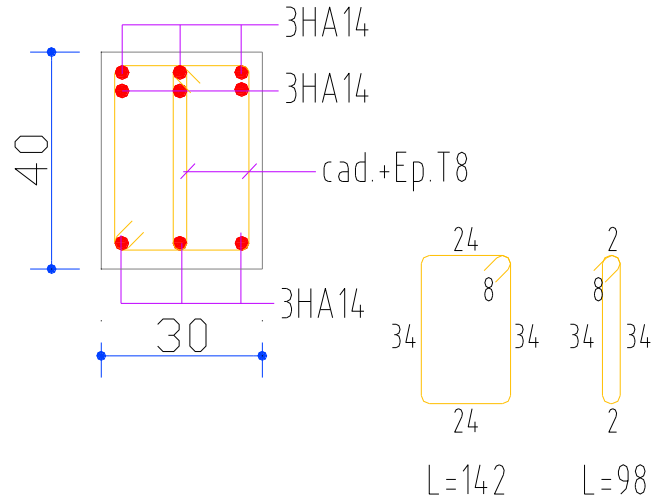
Ferrailage des poutres principales au niveau d'appui de niveaux sous-sol, RDC et terrasse.
